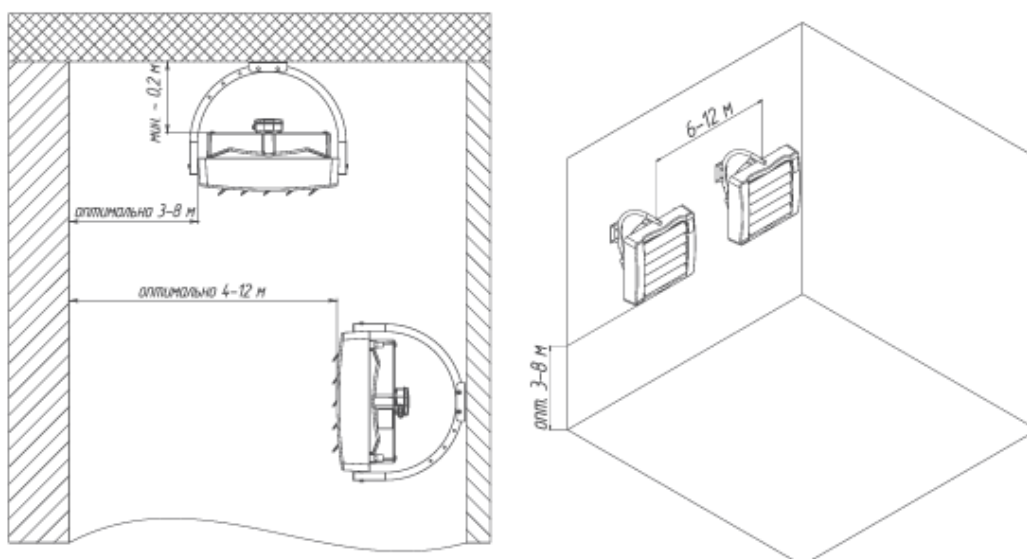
Рекомендации по монтажу водяных тепловентиляторов
